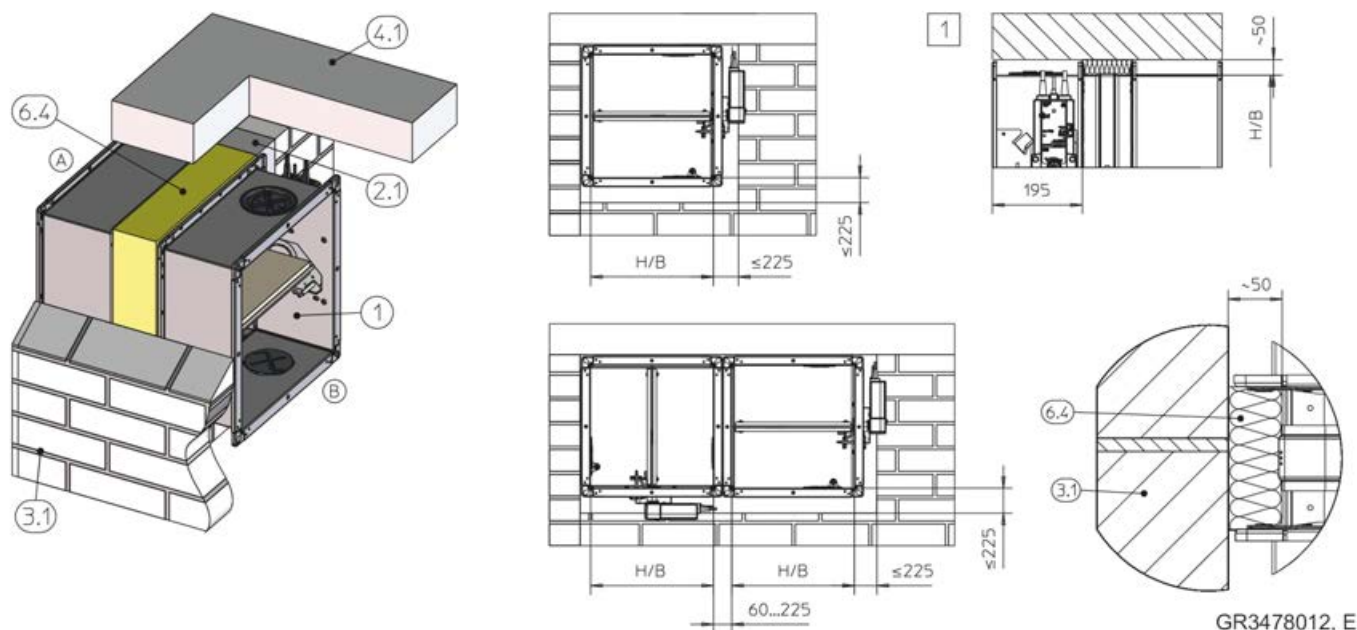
installazione in muratura in una parete piena, con muratura parziale
